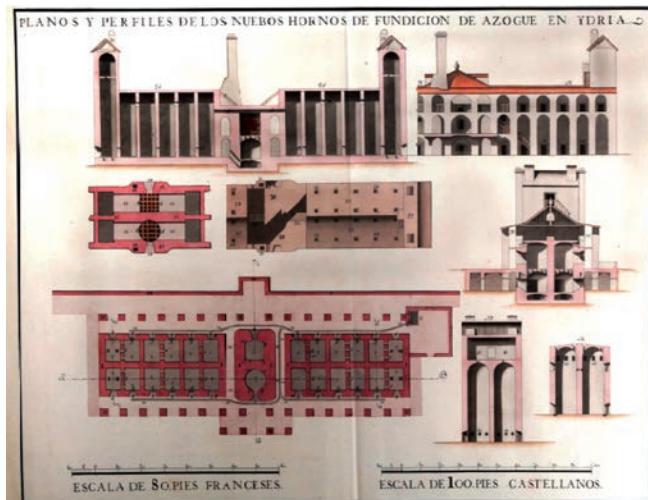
Plano de planta, alzado y perfil en corte con detalles de los hornos.
